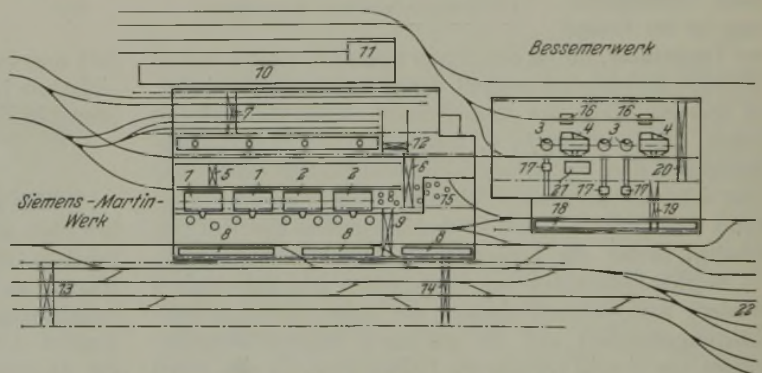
Lageplan der Duplex-Stahlwerksanlage.
